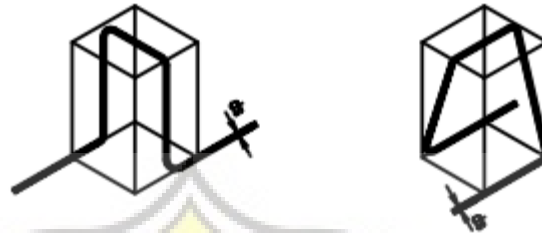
Detail Tulangan Plat Lantai Konvensional
